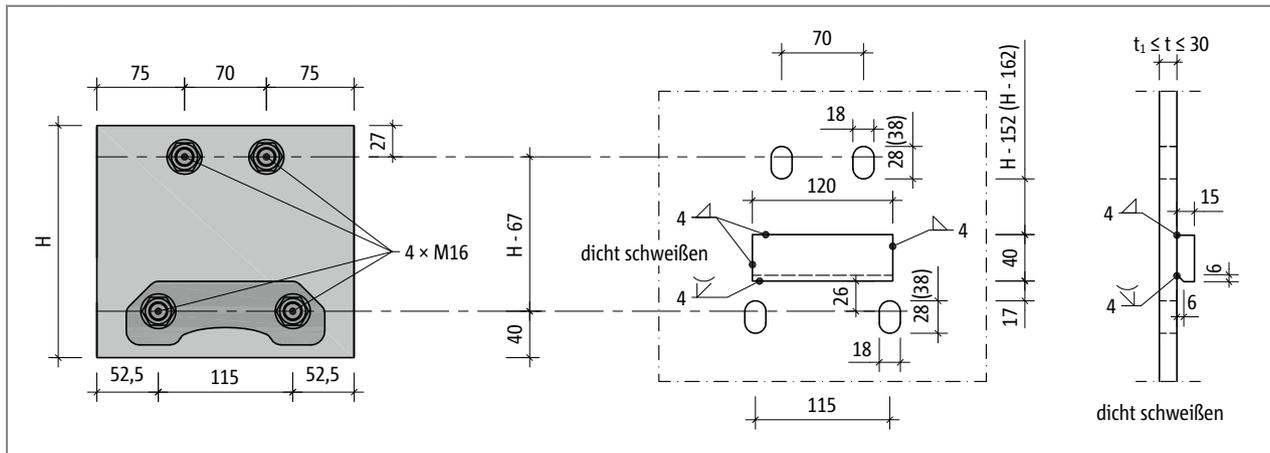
Schöck Isokorb® XT Typ SK-M1: Konstruktion des Stirnplattenanschlusses
